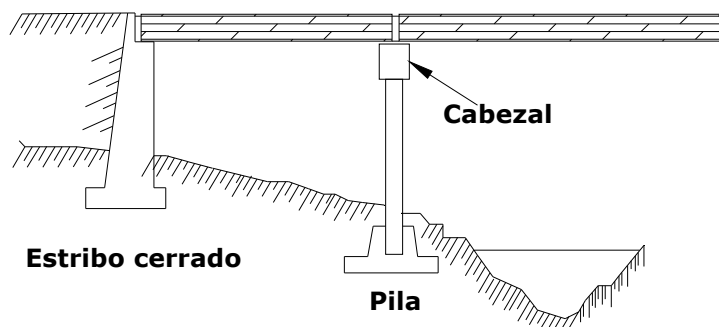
10 Cimentación Superficial – Cimentación Directa
